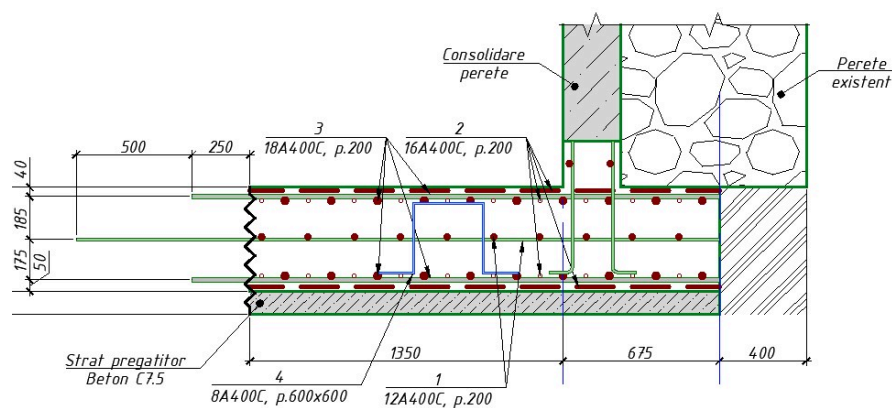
Exemplu de realizare a fundației sub peretele existent [5]
